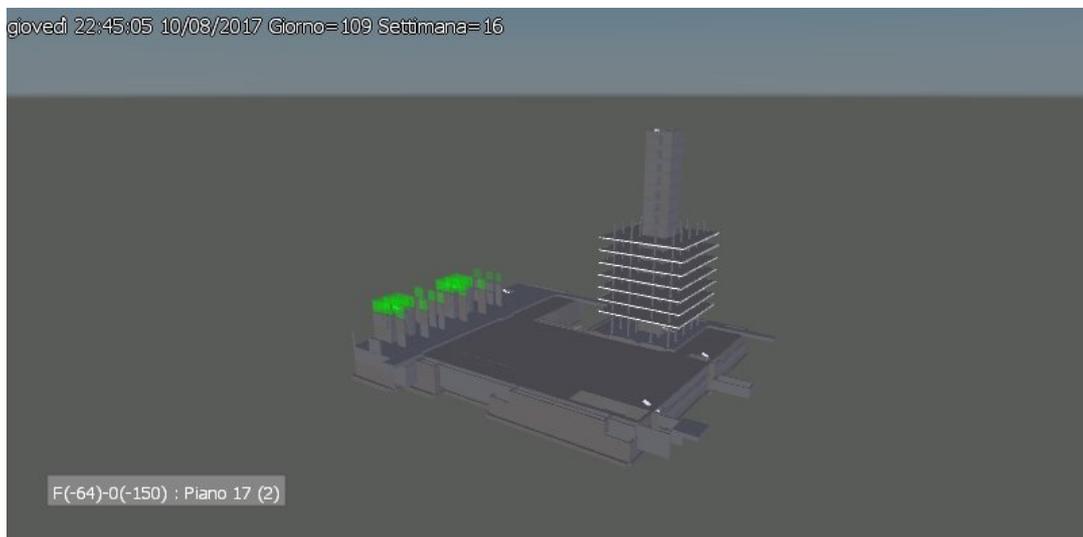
Simulazione 4D - Elevazione Tower ed elevazione vani scala B e C Garden
